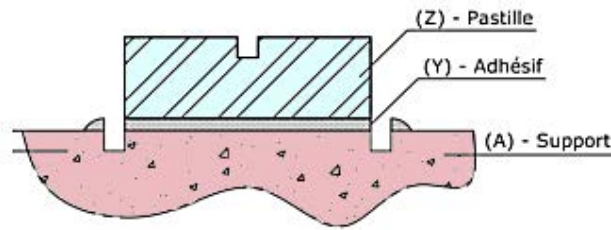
schéma de l'essai d'arrachement du béton dans le cas d'un support non-revêtu (NF EN 1542)
